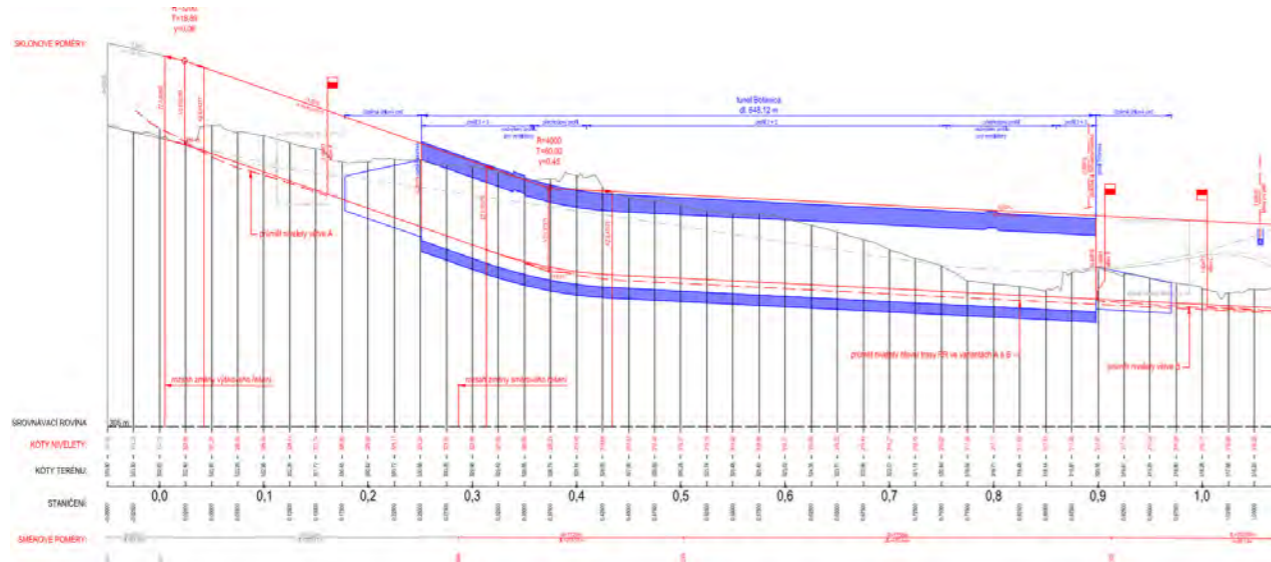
Oblast MÚK Řeporyjská – podélný profil RR varianta A
